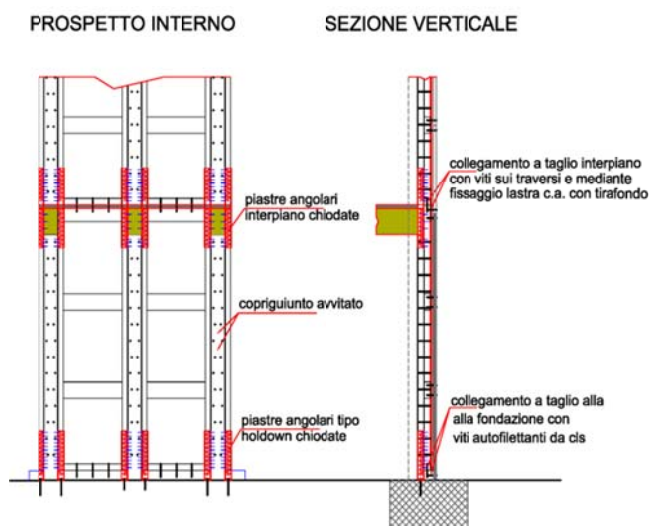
Elementi di connessione – prospetto e sezione verticale.
